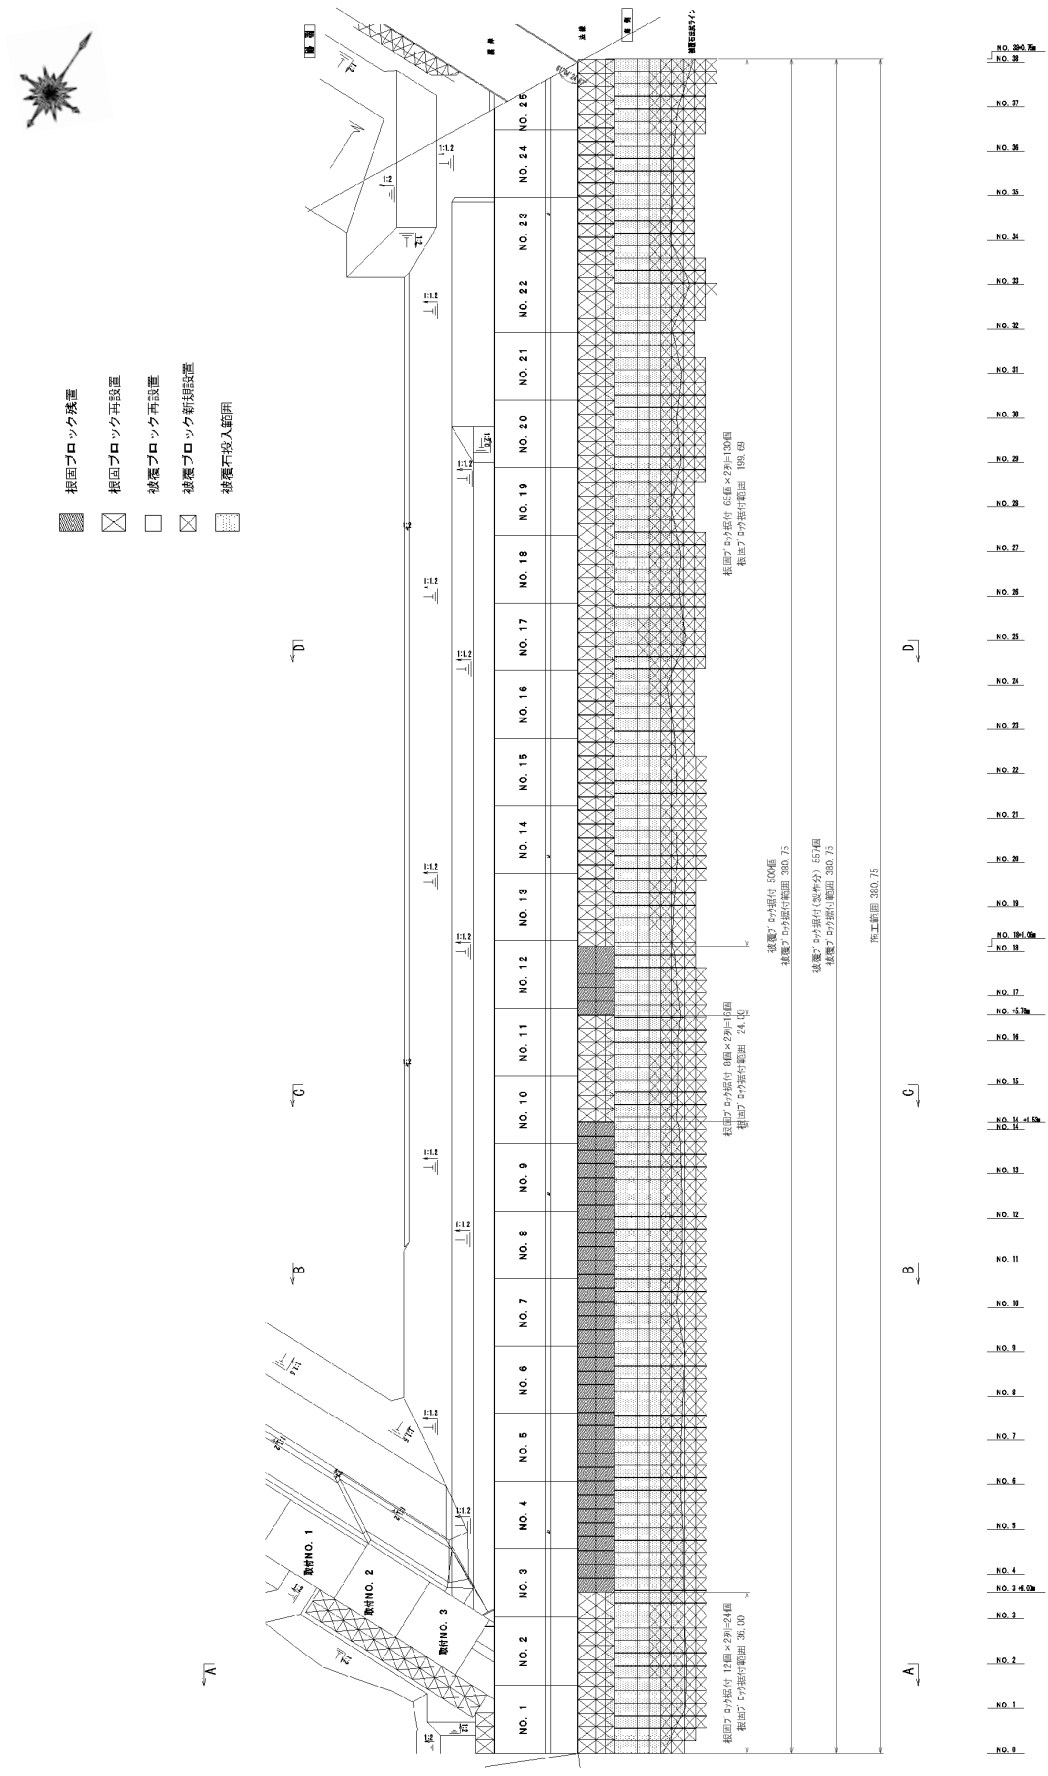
No.1 外港地区防波護岸平面図（復旧後）_復旧平面図
